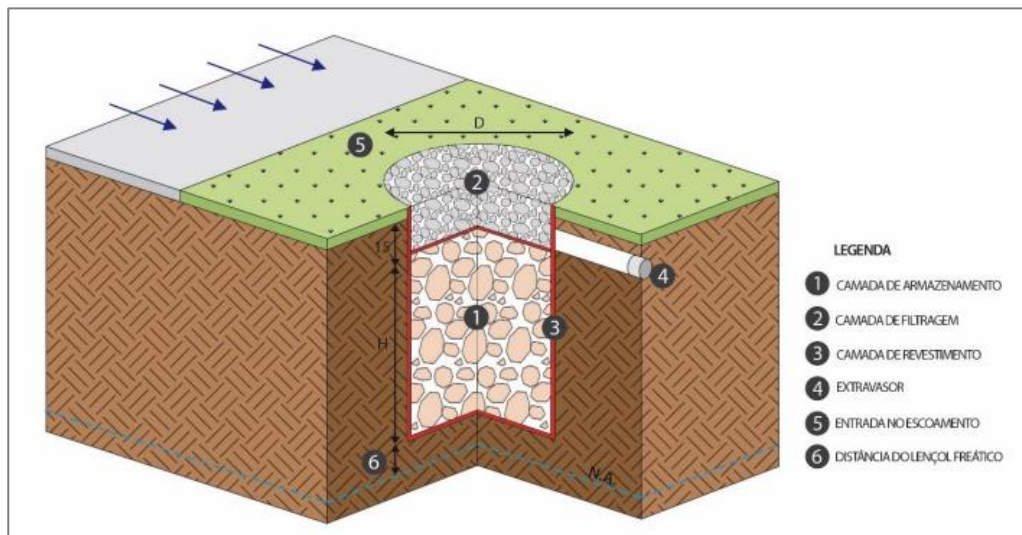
CONFIGURAÇÃO DE UM POÇO DE INFILTRAÇÃO
